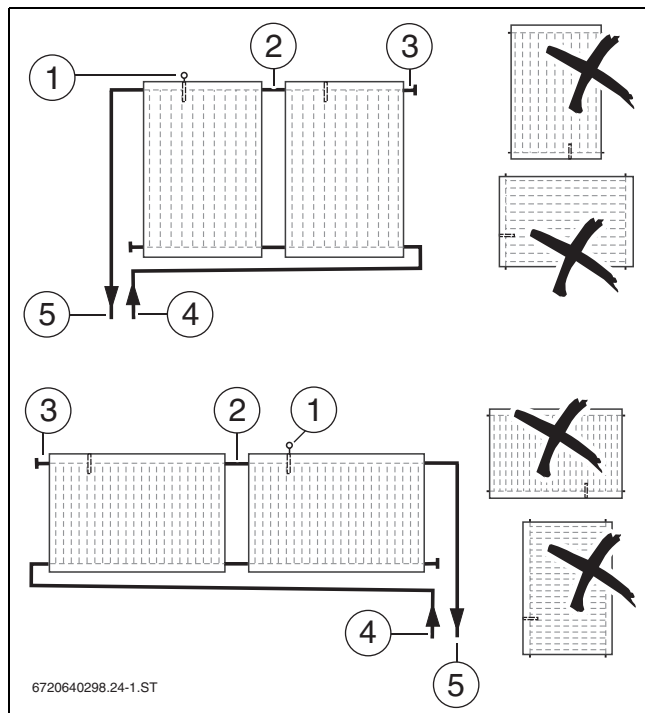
Disposição de colectores verticais (em cima) e horizontais (em baixo)
